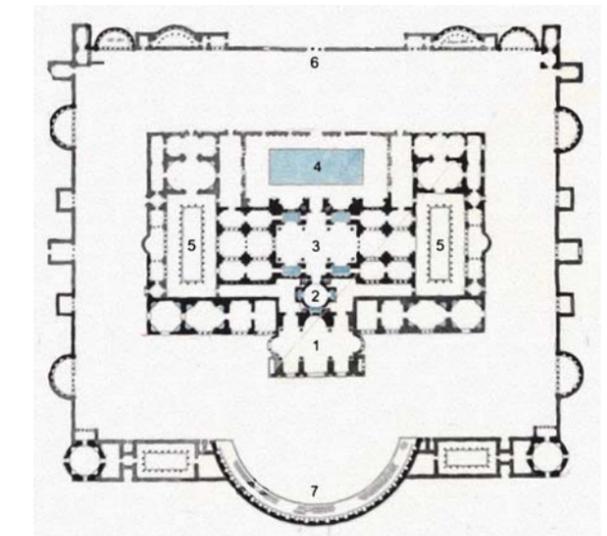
Grundriss der Diokletiansthermen in Rom [12]
